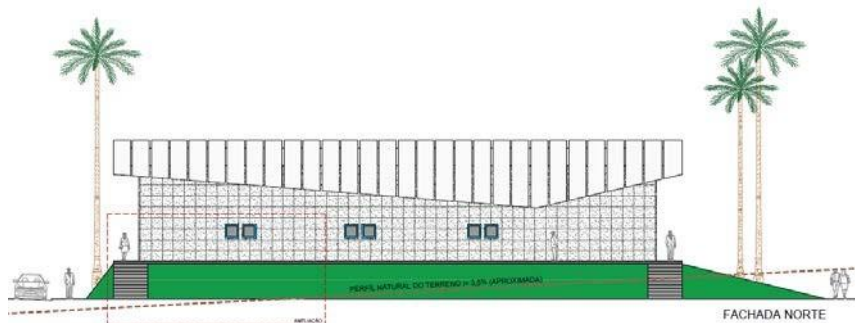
Croqui da fachada norte. (Fonte: Autores)
